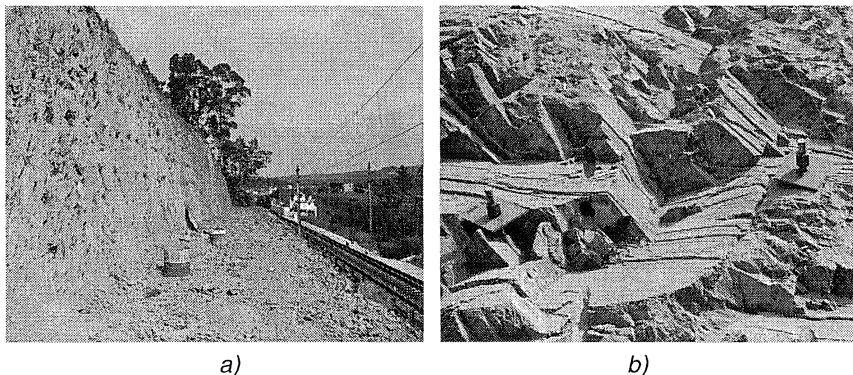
Modelado y refuerzo de talud - aspectos constructivos
